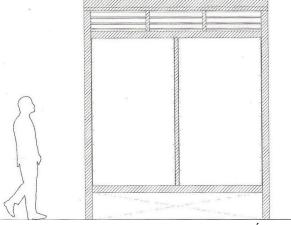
FACHADA OESTE (MÓDULO 10X10).
